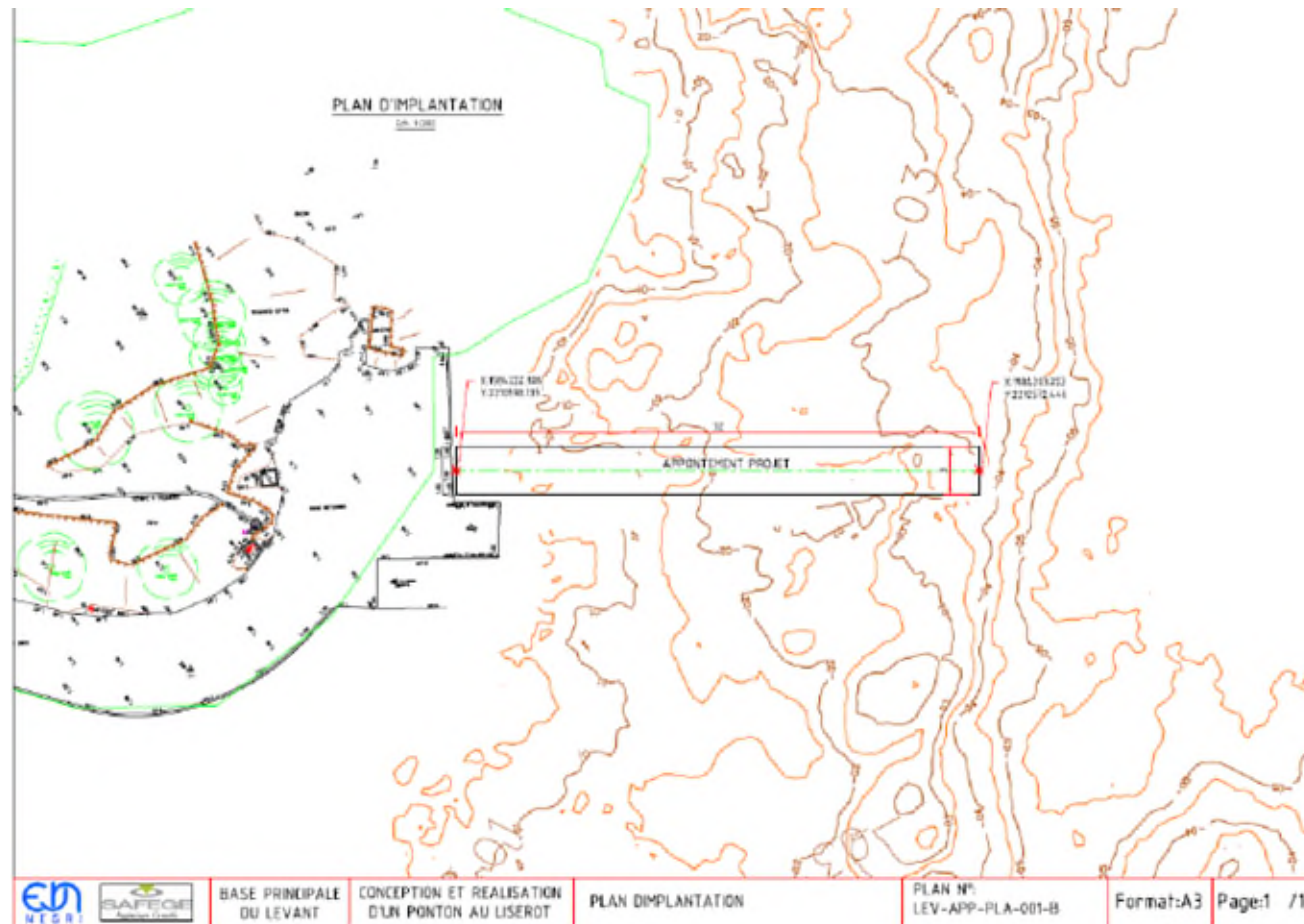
Plan masse du projet (source : dossier loi sur l'eau réfection du ponton de Liserot)
